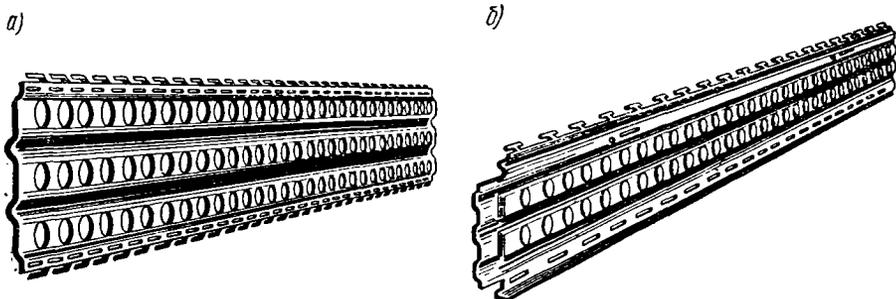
Конструкция металлических плит сборно-разборных покрытий:
